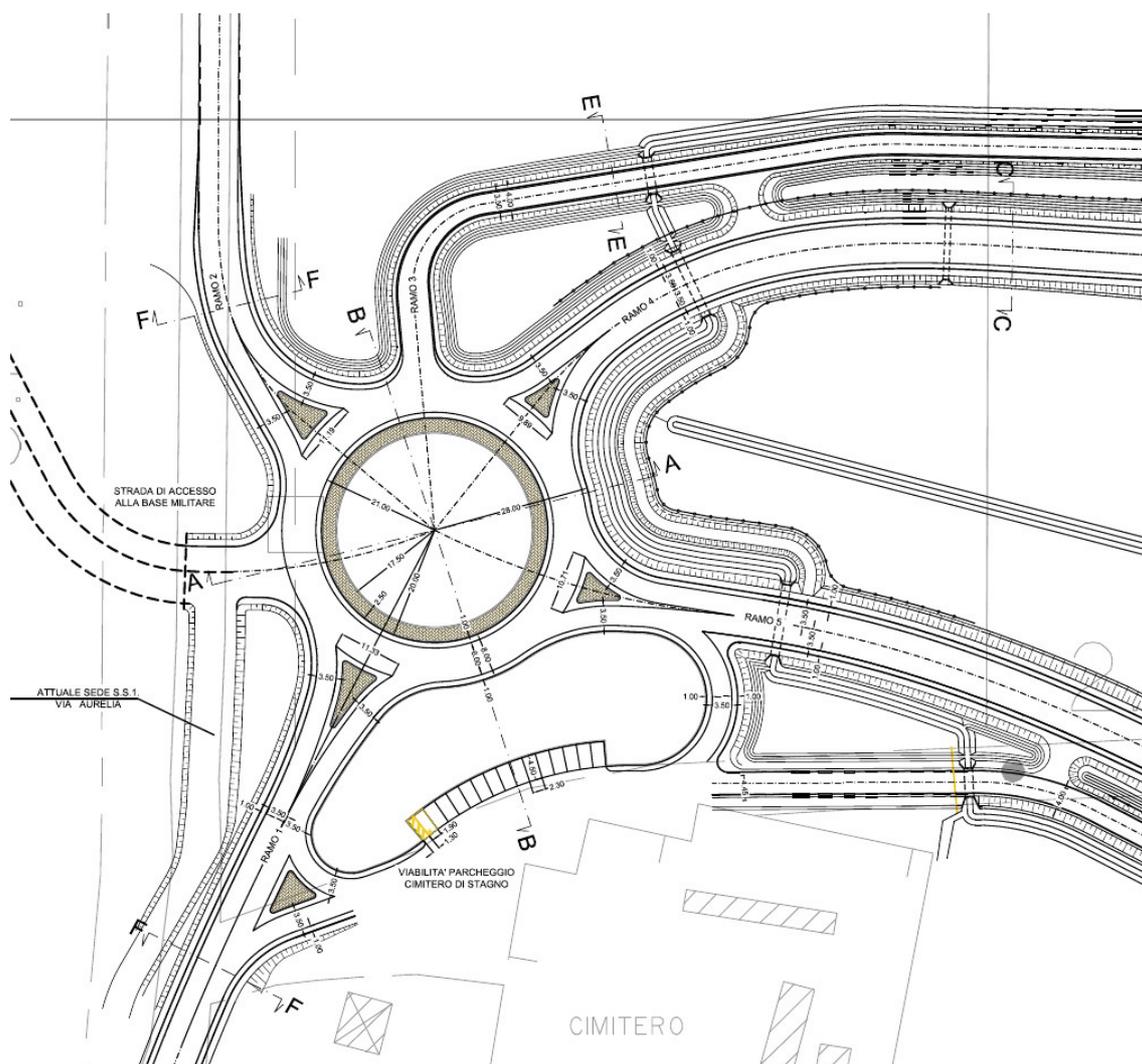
Planimetria di progetto – Particolari rotondina e parcheggio cimitero
